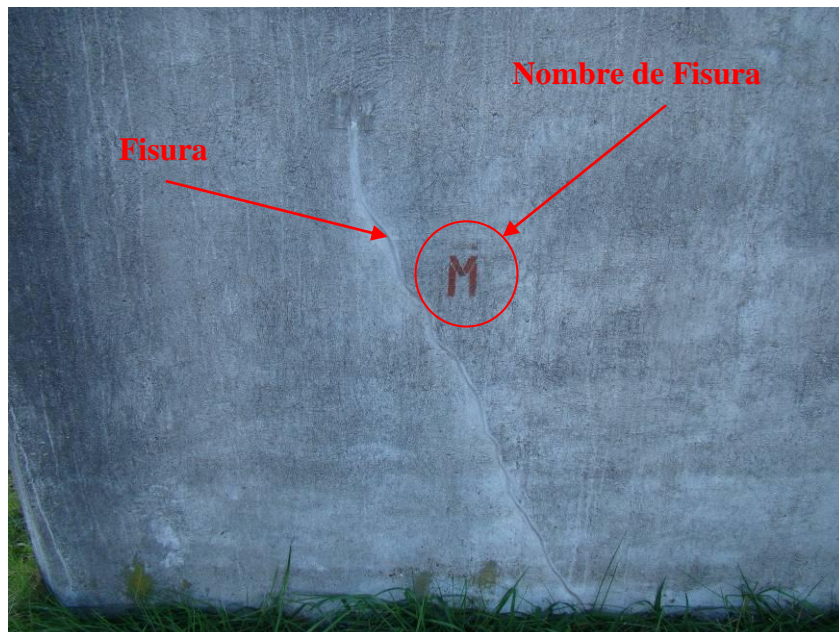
Vista de una fisura sellada y nombrada por personal de la CARU. Pila 3, cara externa lado Uruguayo.
